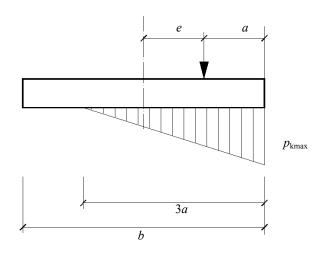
偏心荷载 (e>b/6) 下基底压力计算示意 b—力距作用方向基础底面边长
